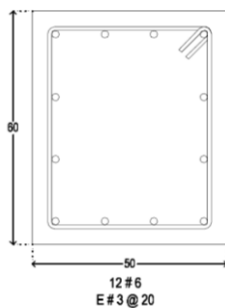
Arreglo de zapata corrida ZC-2 para edificio eléctrico
